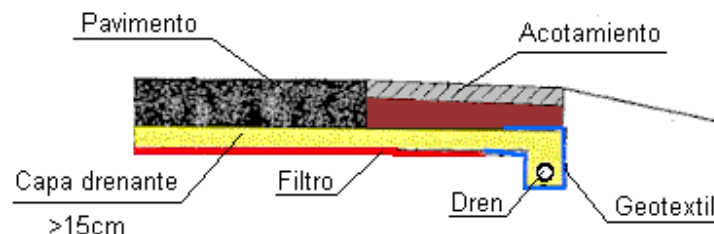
CAPA DRENANTE CON GEOTEXTILES
